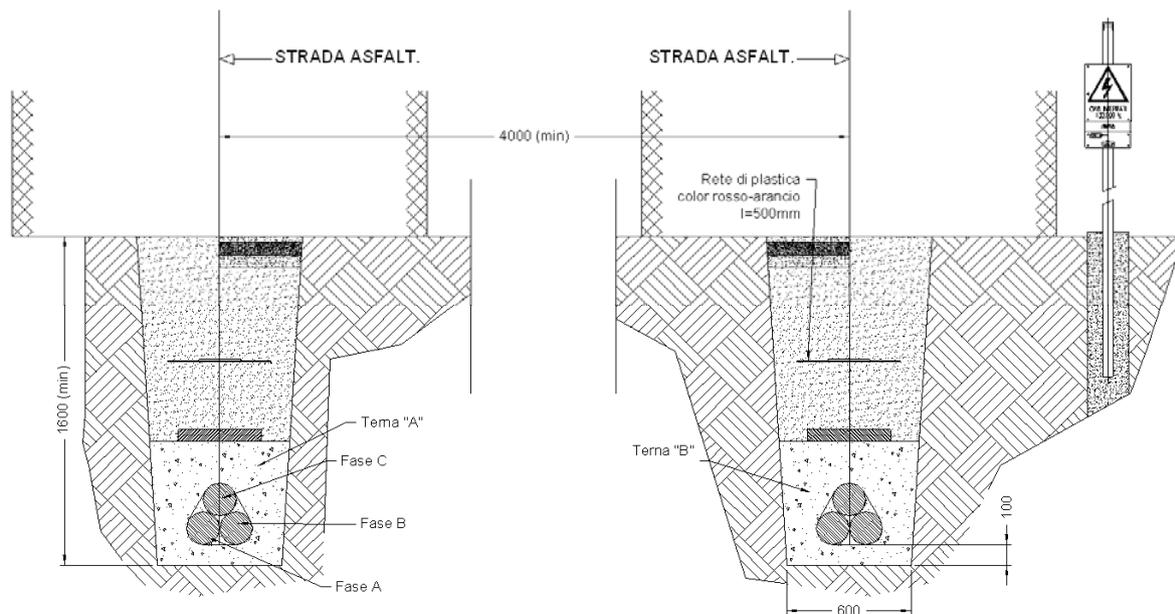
Sezione tipo "A" – Disposizione conduttori
